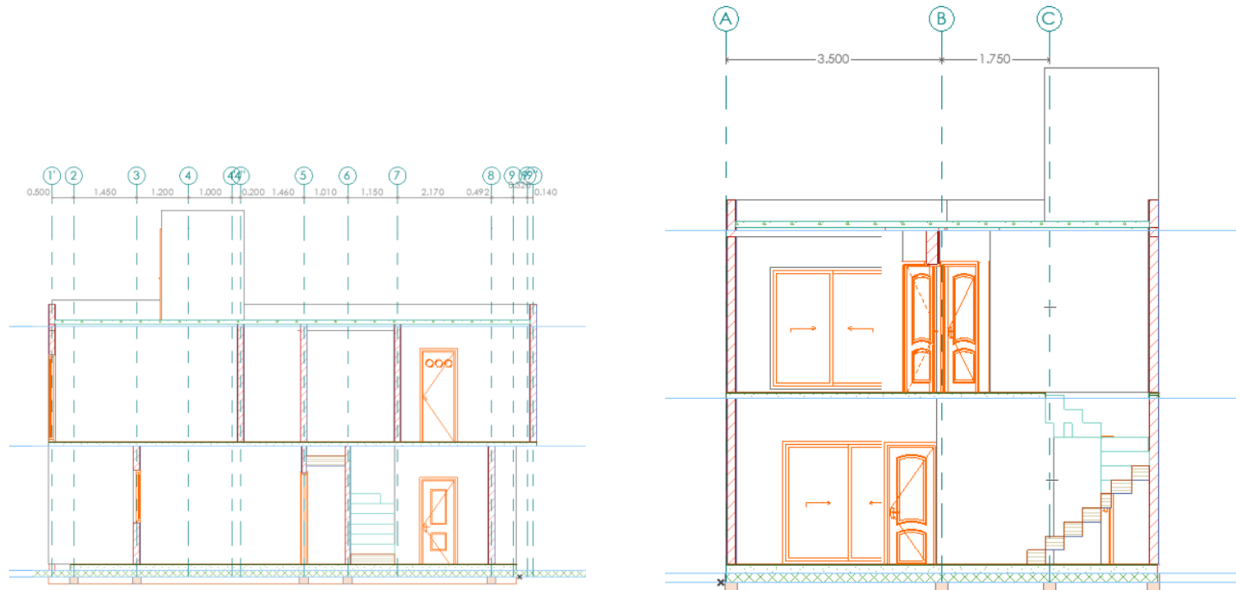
Corte 1 Longitudinal y corte 2 transversal
